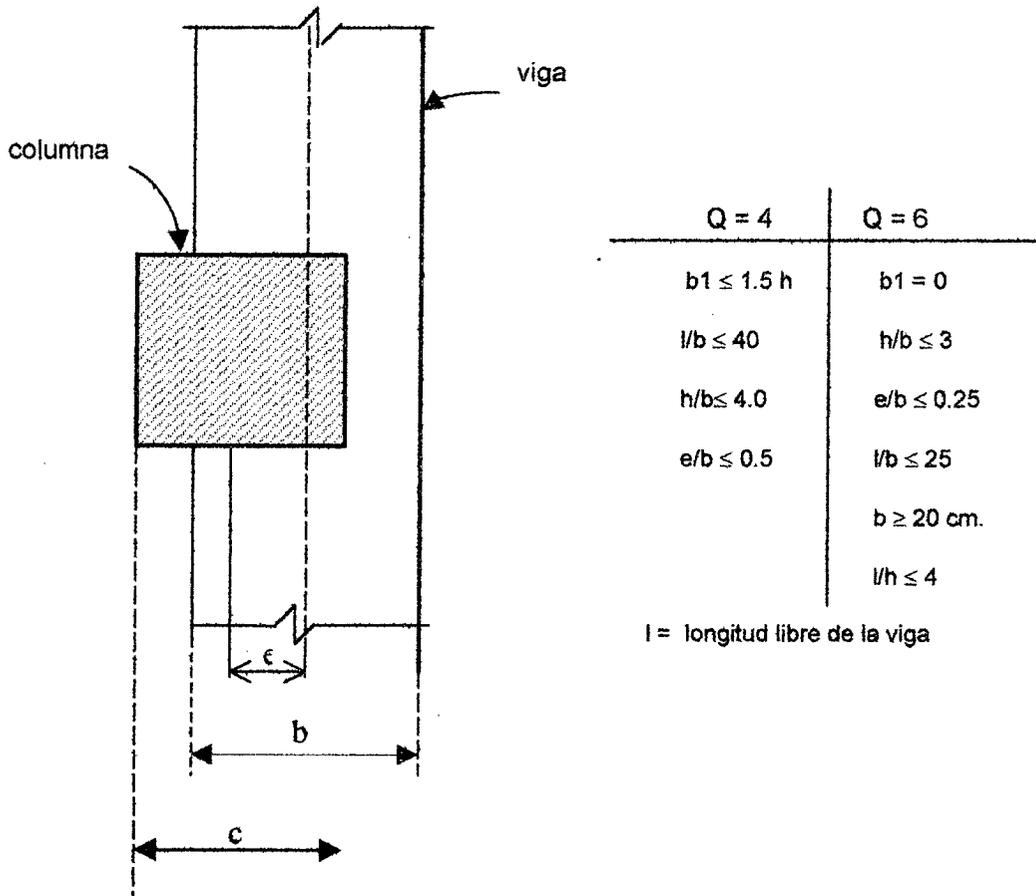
c.1 Requisitos geométricos para vigas de concreto reforzado
